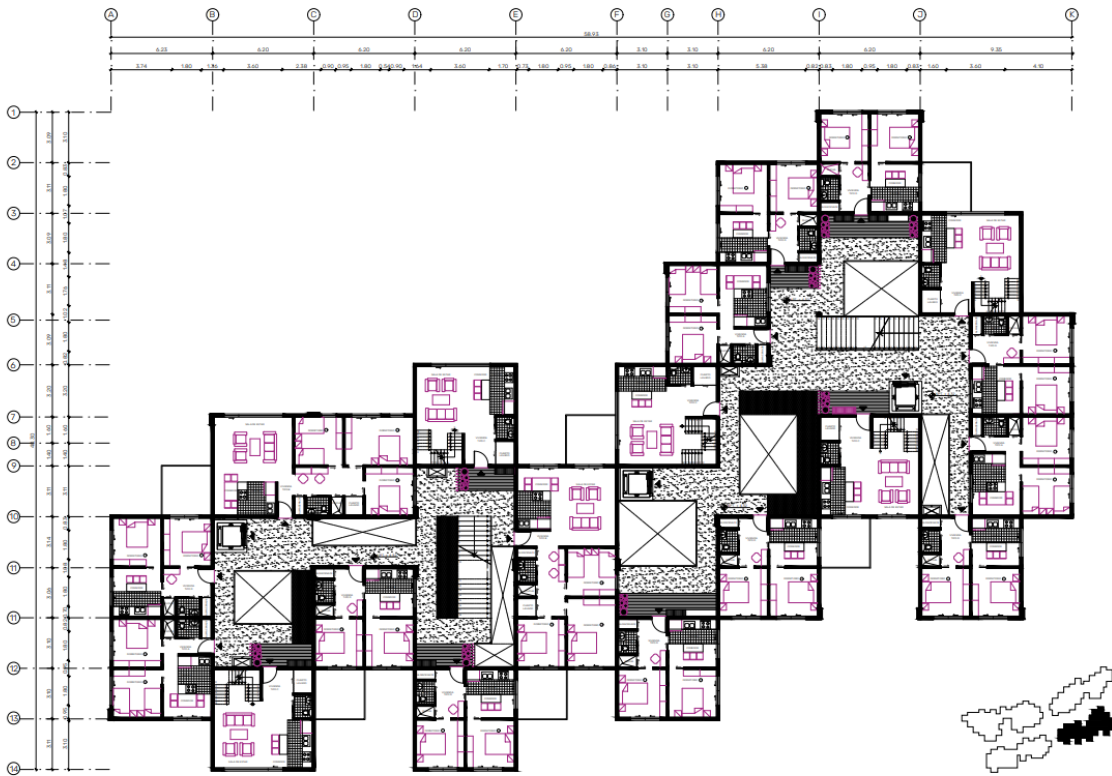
Planta nivel 2 Bloque 4. Elaboración propia 2023
